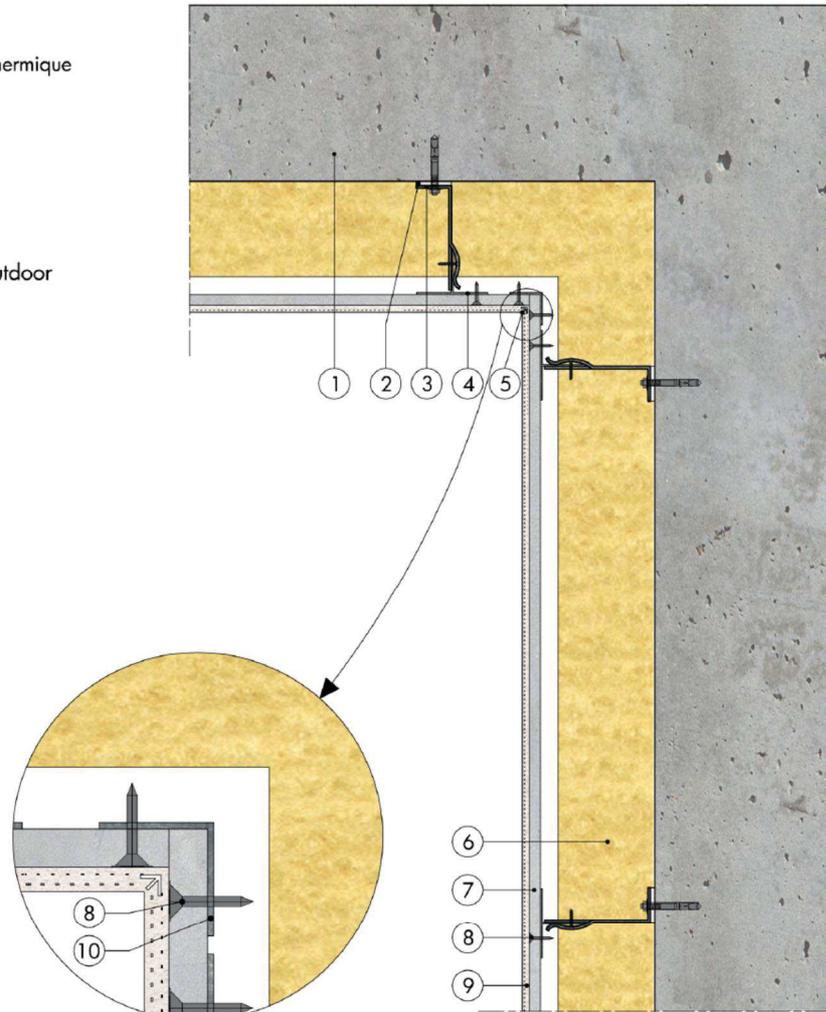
Mise en œuvre des plaques Aquapanel Outdoor + enduit de base en angle entrant
